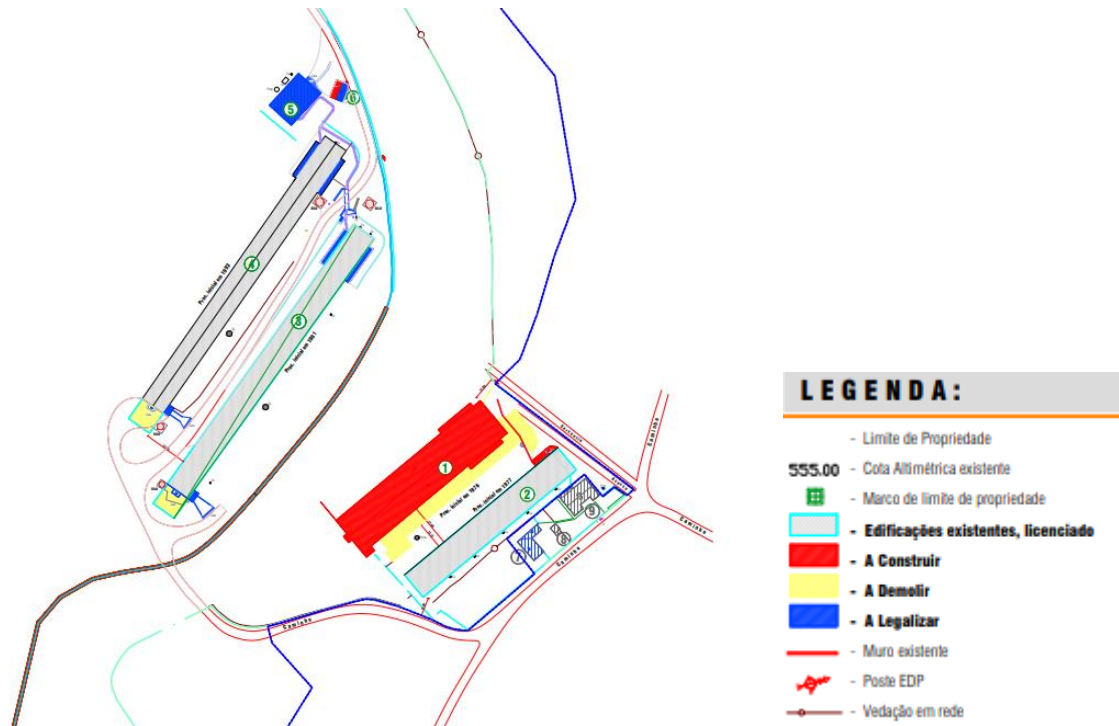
Extrato da planta de alterações com as cores convencionais, Anexo B - Fonte: Volume II. Anexos Técnicos
